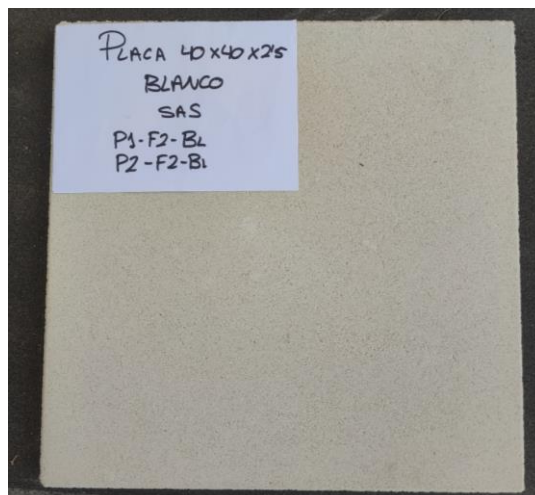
Fotografía pavimento Blanco SAS1900. Fuente: Elaboración propia.
